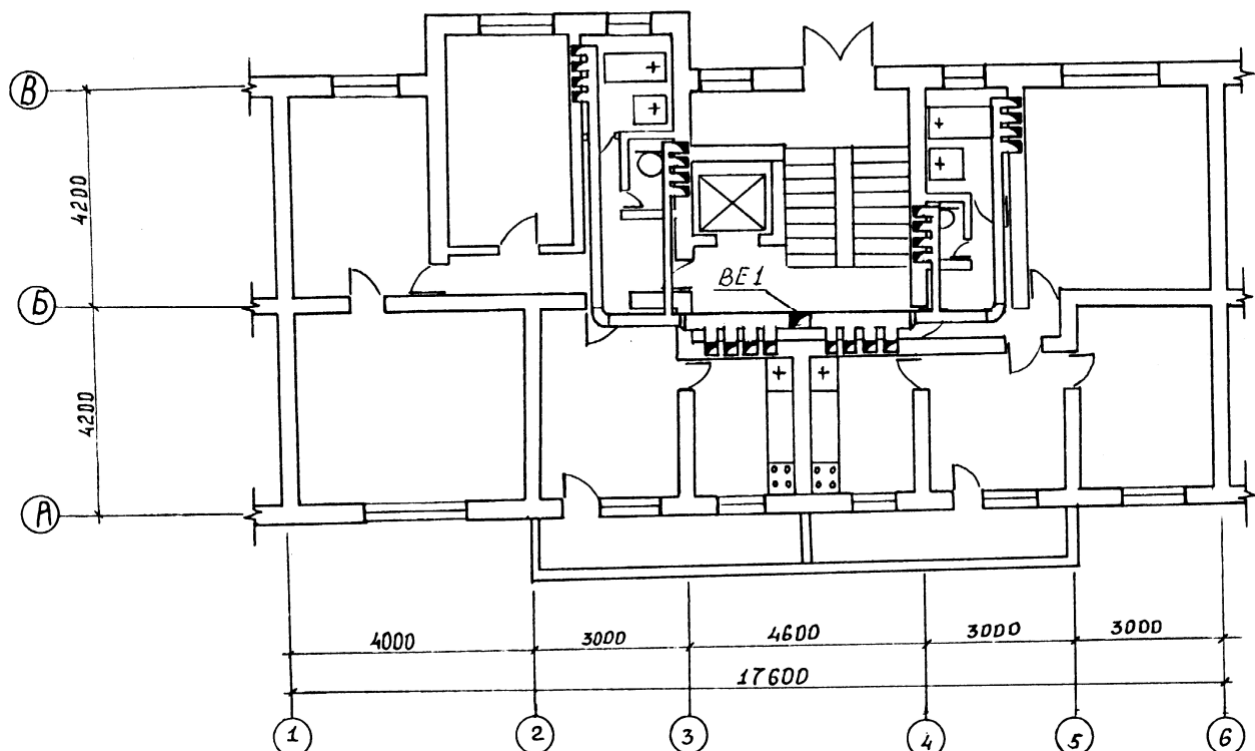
Розміщення каналів і повітроводів на плані останнього поверху 7-поверхового будинка
